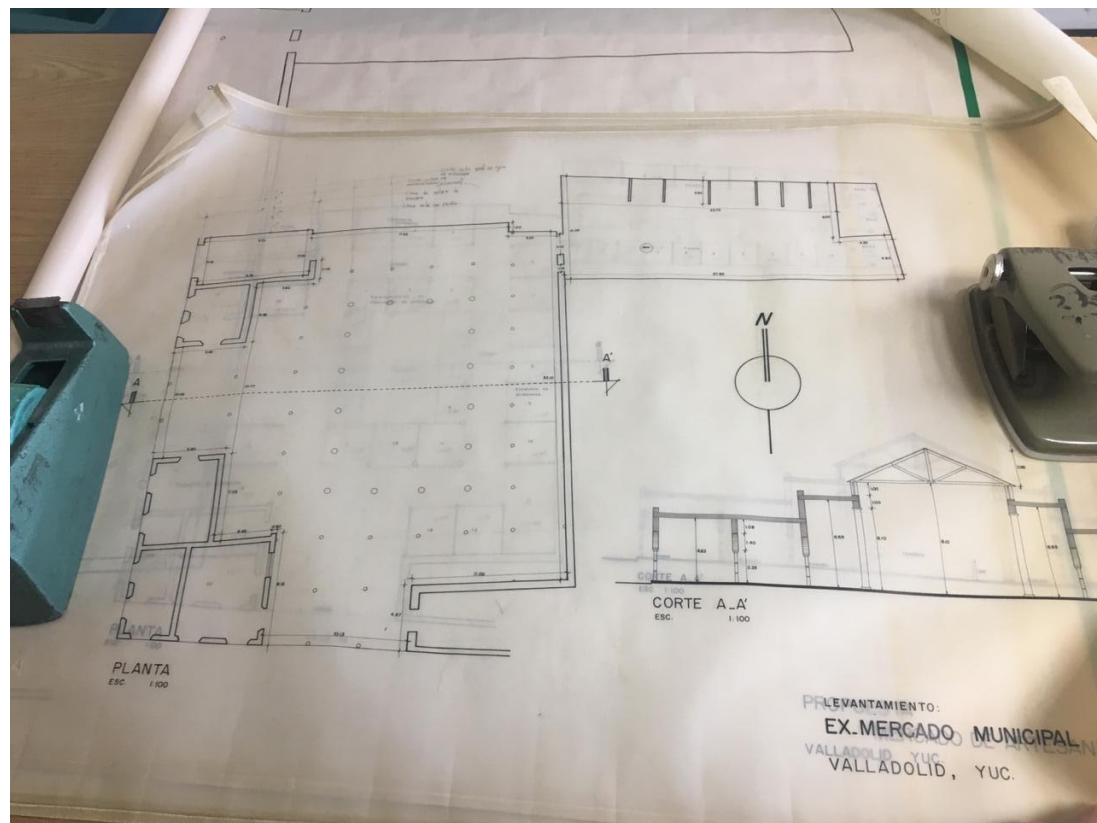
Plano de levantamiento arquitectónico del antiguo Mercado Municipal de Valladolid. Cortesía del arquitecto Carlos A. Cosgaya Medina, encontrado en el Archivo Central de la Nación.
